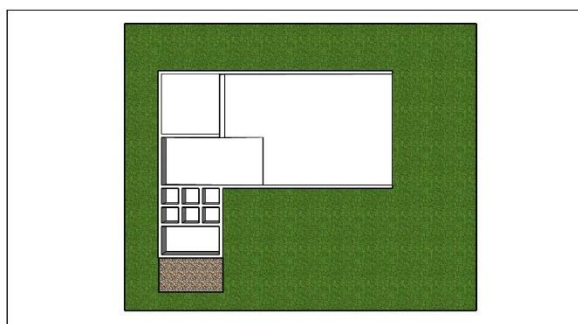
Exemplo da Plataforma de lavagem dos caminhões betoneiras e sistema de processamento
